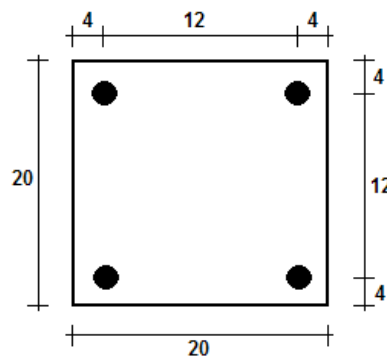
Croquis do Detalhamento da Seção de 20x20 cm² com 4 ϕ 10 mm
